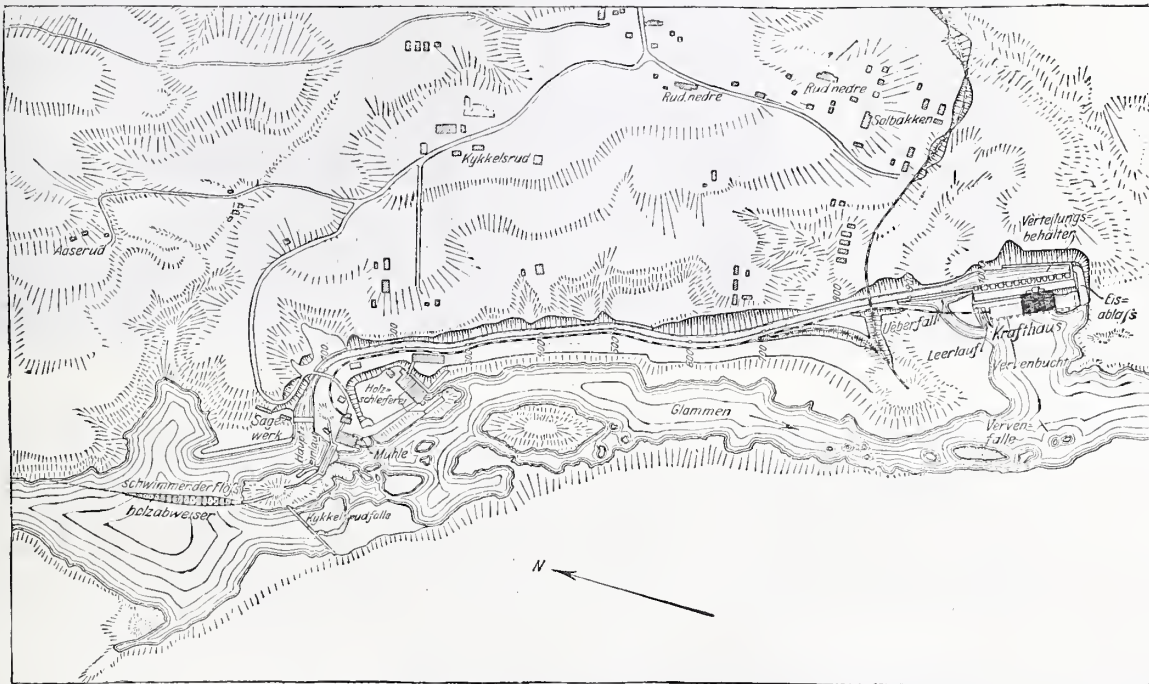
Lageplan der Wasserwerksanlage. — Masstab 1 : 10 000.
